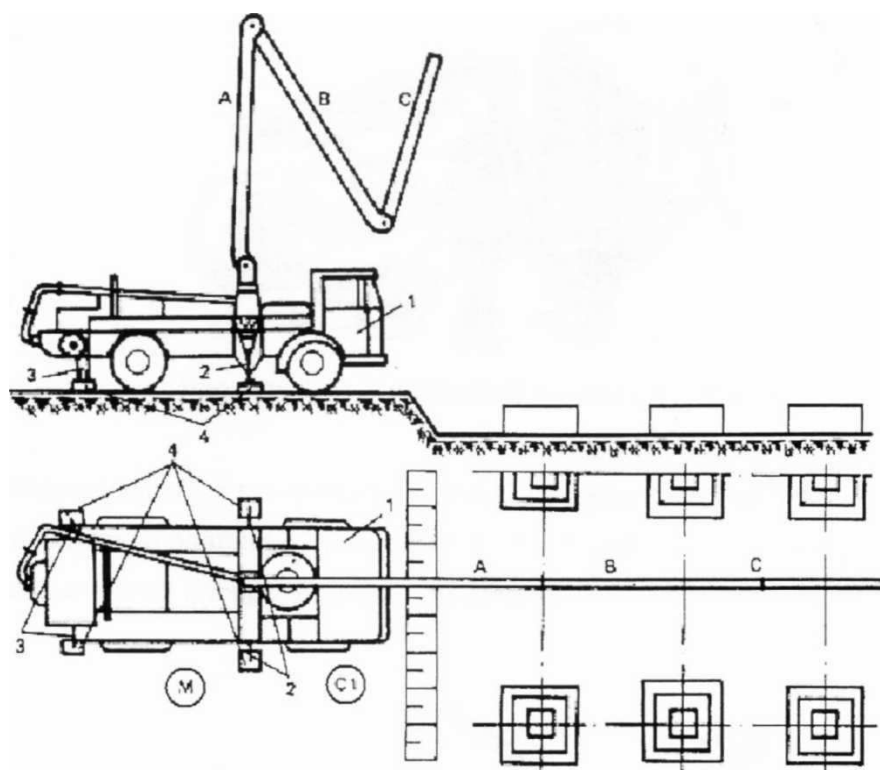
Схема организации рабочего места при выполнении работ по бетонированию фундаментов
